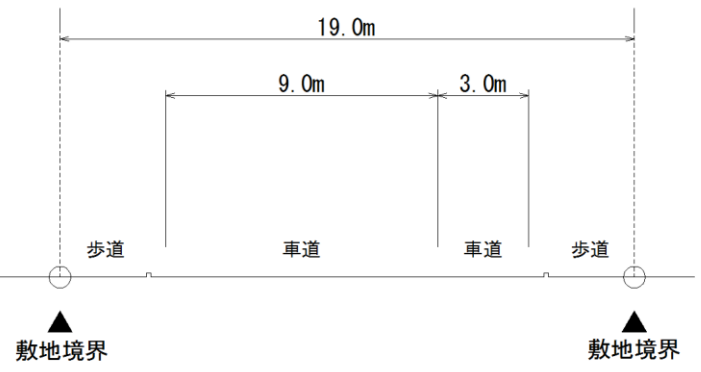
(5) 予測断面図 (E. 一般国道464号 (2))
